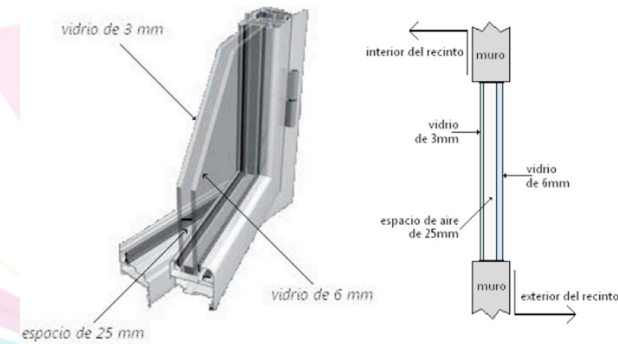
Detalle constructivo ventana. Vanessa Cruz 2014.
